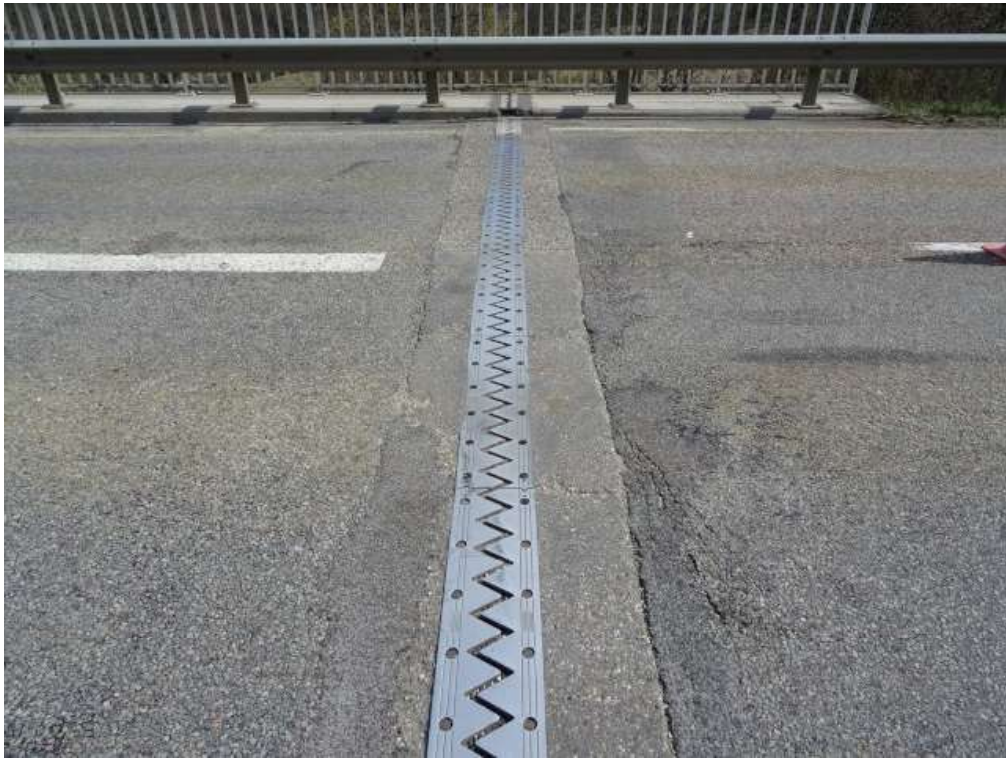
Vue sur le joint de chaussée côté Saint Laurent.
